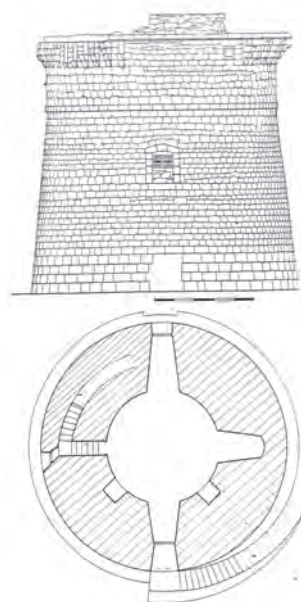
Planta y alzado de la Torre de la Isleta según el levantamiento planimétrico previo a su restauración. Autor: Marius Bevià. Año 1984.
